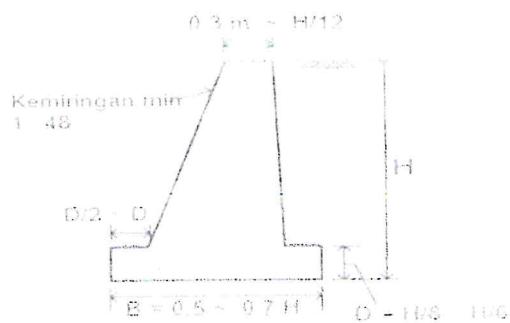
Cantilever Type Ground Retaining Wall (DPT)
